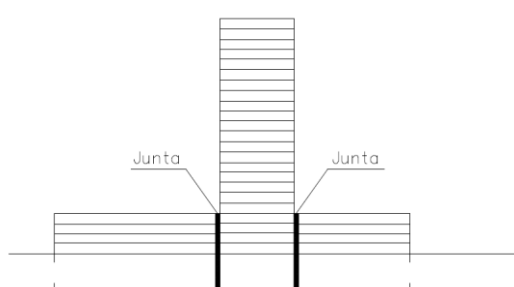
Estruturas com fundações com fraca adaptabilidade a movimentos horizontais. (André, 2008)
